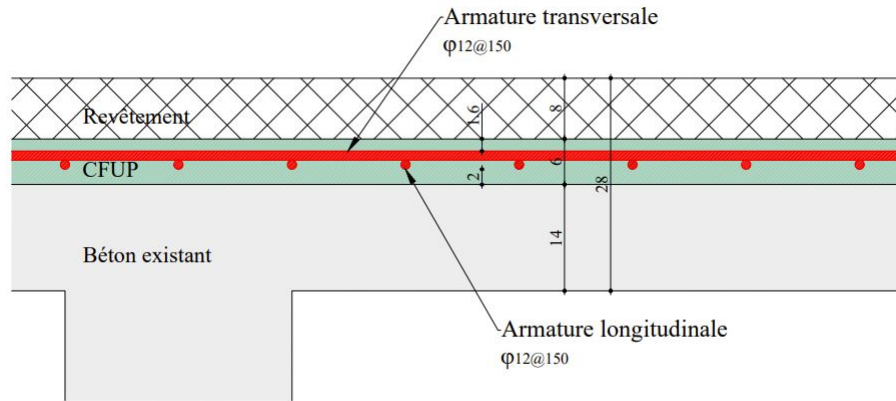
Renforcement de la dalle de roulement au moyen d'une couche de CFUP
